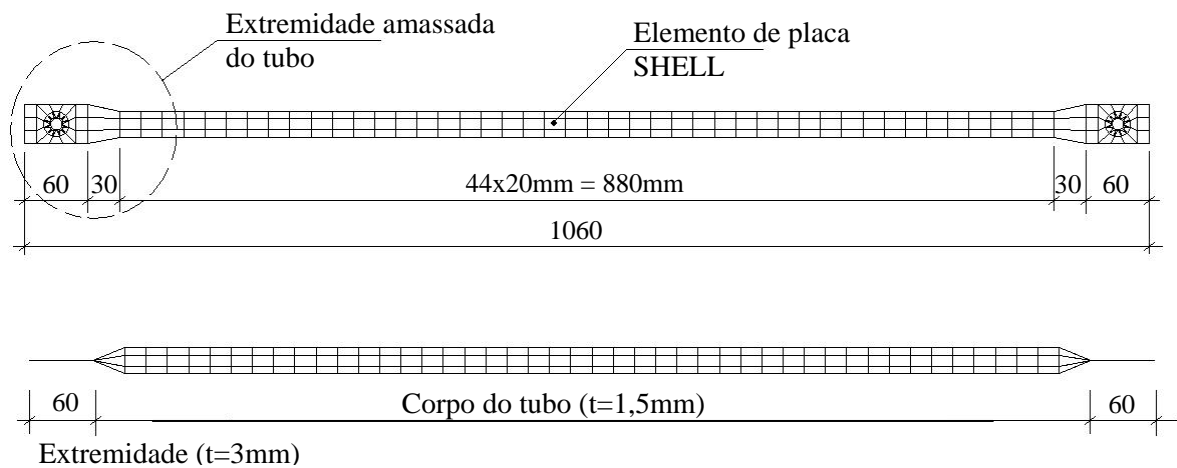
Planta e elevação do banzo da estrutura (cotas em milímetro)
